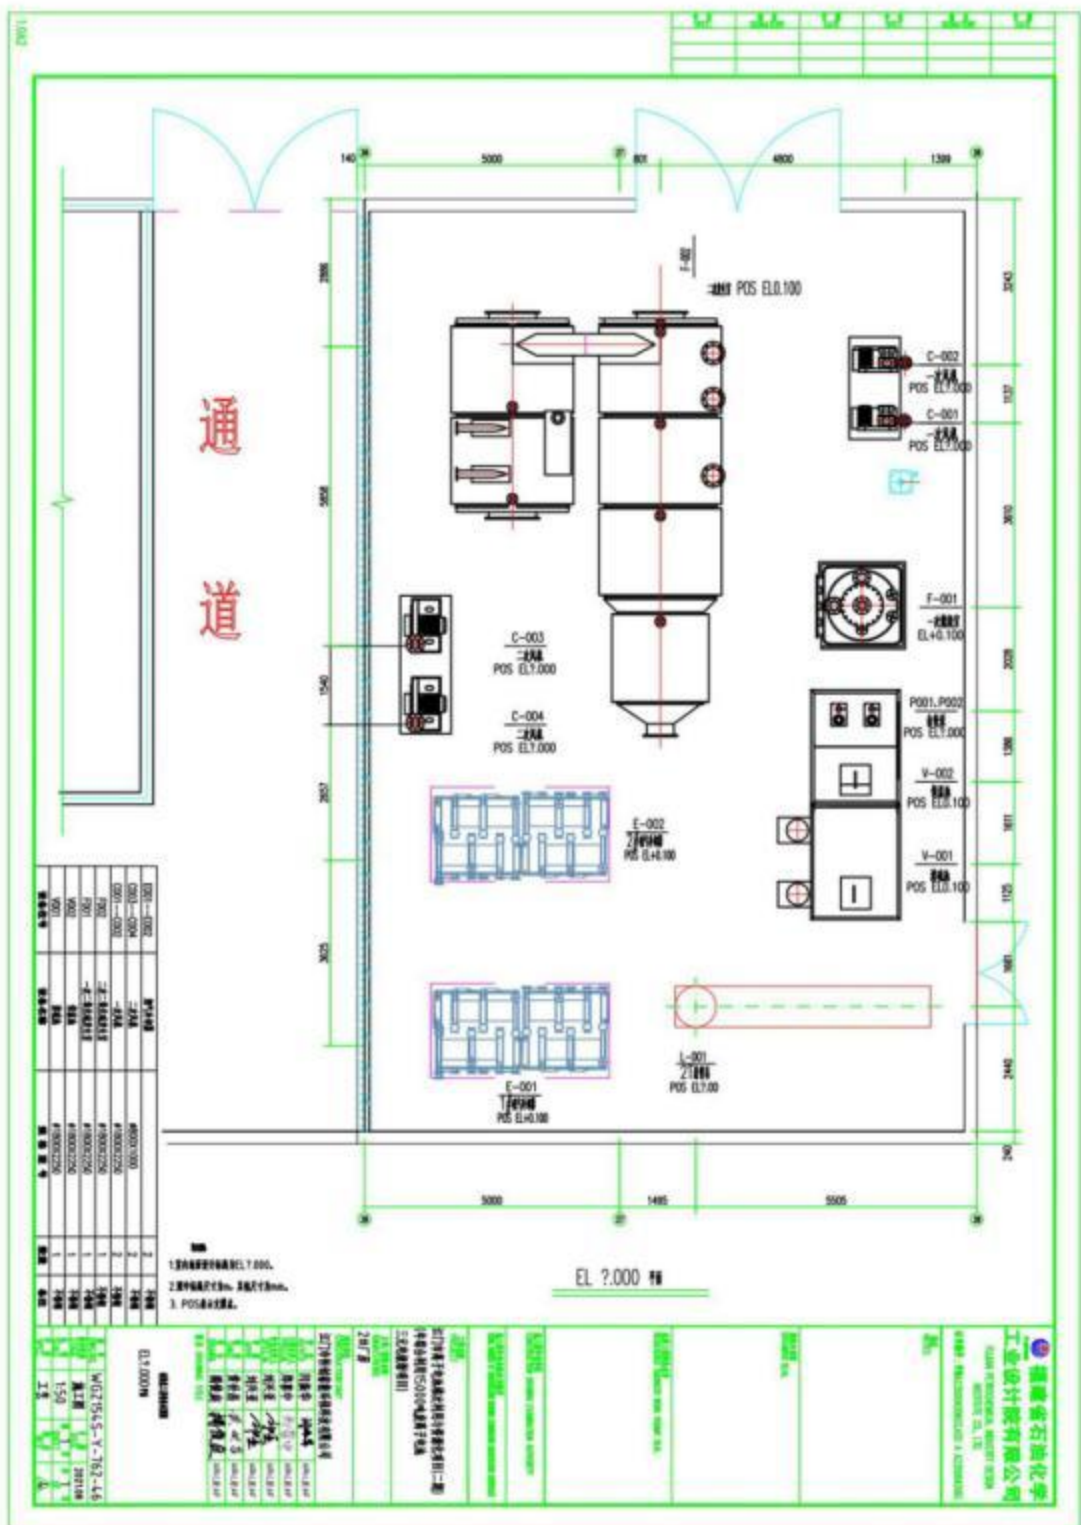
2#厂房-硫氧化区域平面布置图
